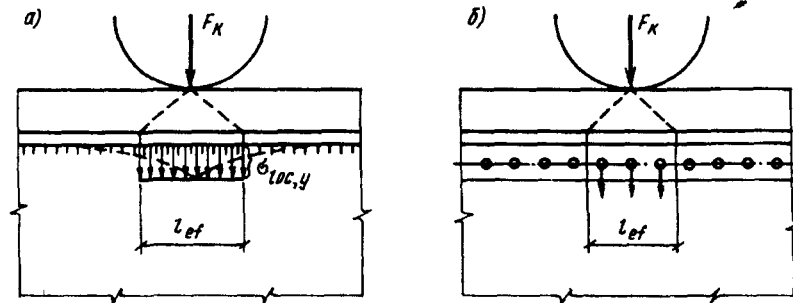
Местные напряжения в стенке подкрановых балок под колесом крана
